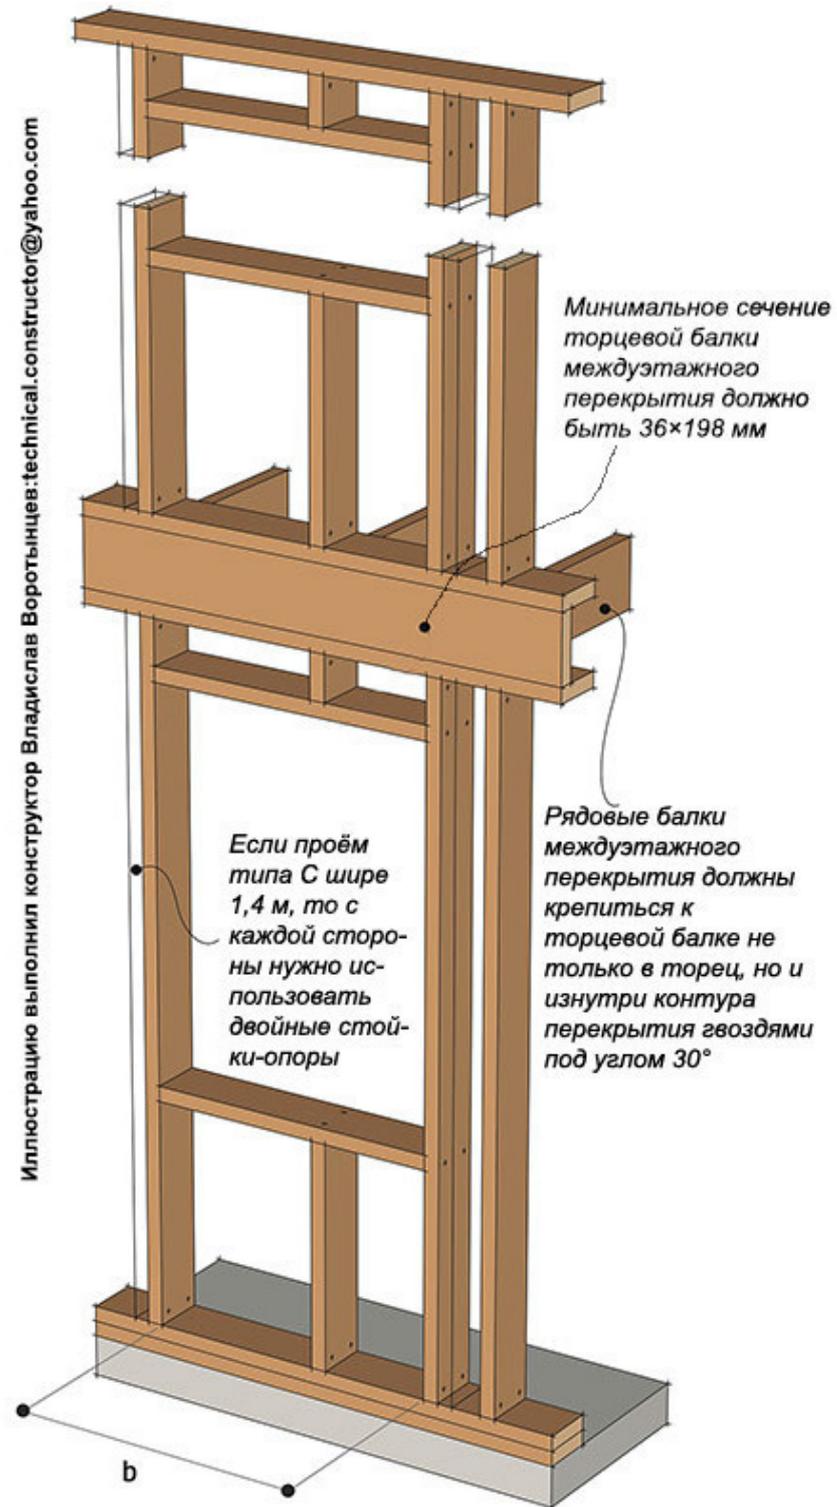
Проём в несущей стене с нагрузкой только от междуэтажного перекрытия. Проём типа С
